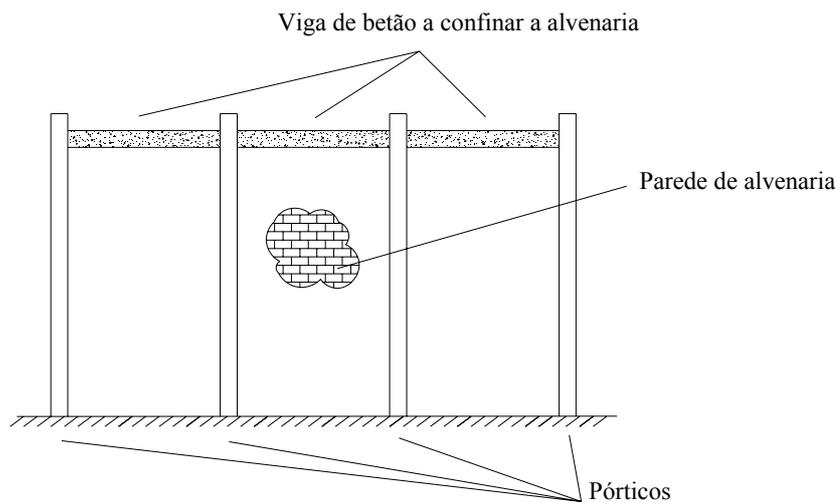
Contraventamento lateral dos pórticos por alvenaria
